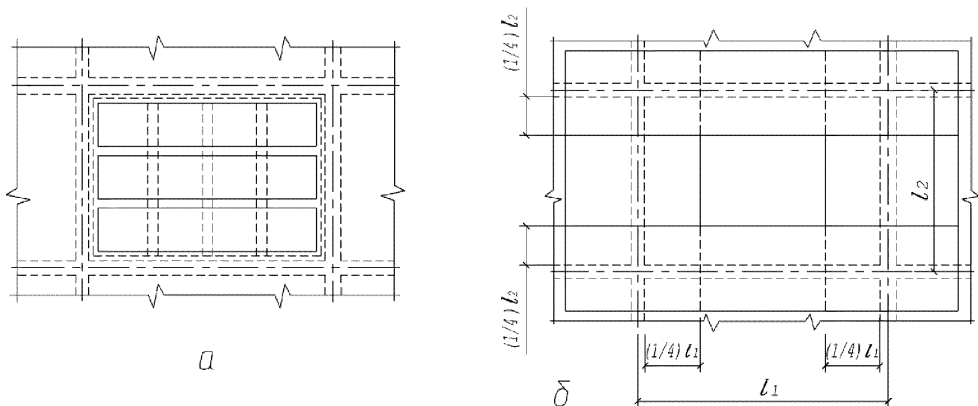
Схема армирования опертой по контуру плиты плоскими сварными сетками: *а* – узкими пролетными; *б* – надпорными
